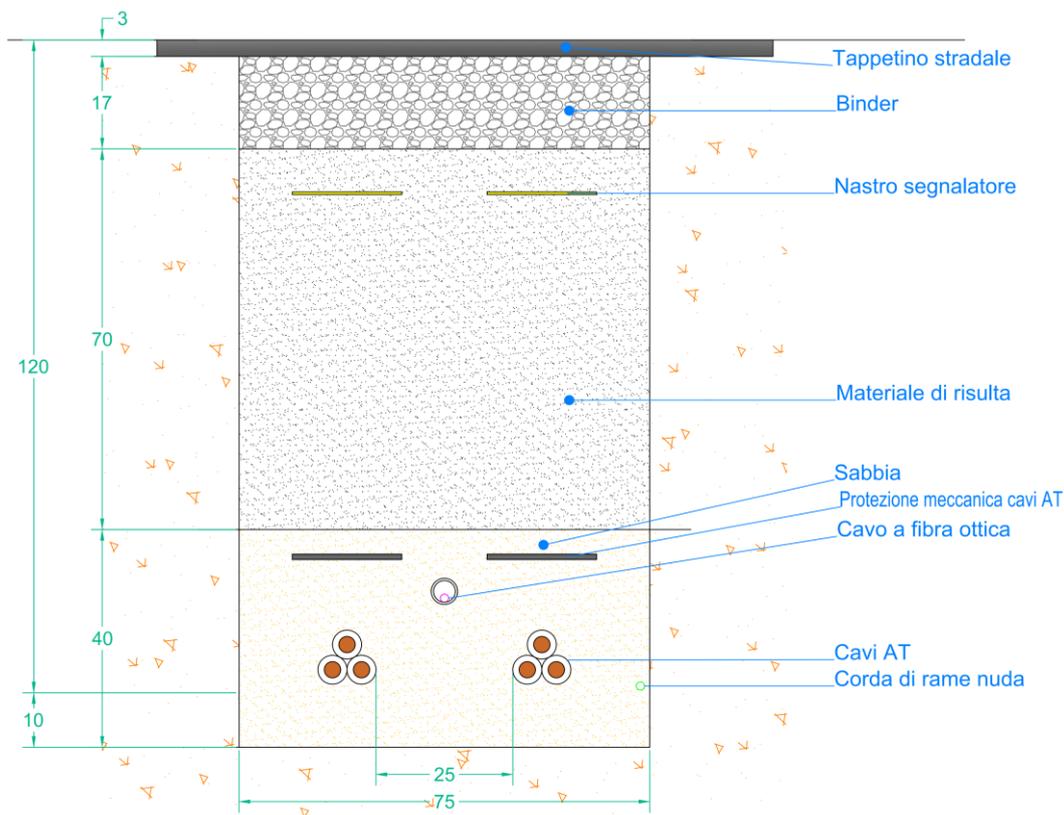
Sezione tipologica cavidotto interrato su strada (interno al Campo) – doppia terna in scavo
